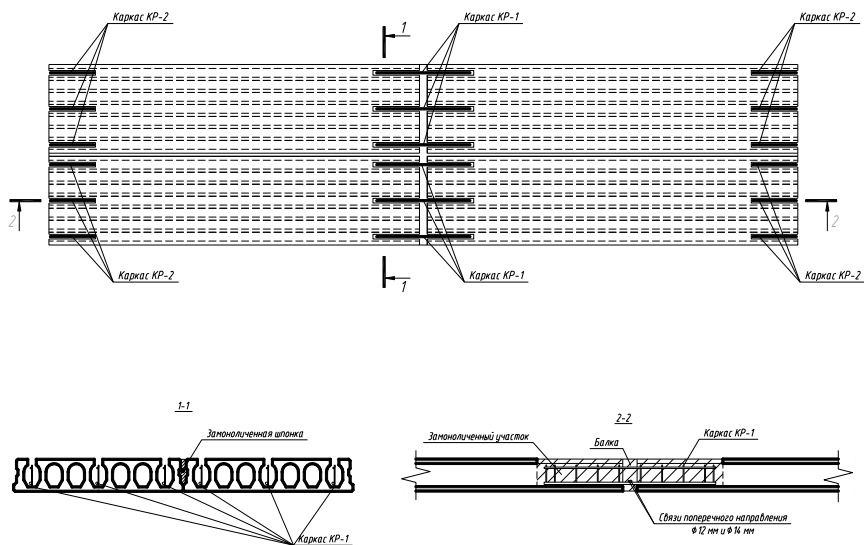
Конструкция опытного фрагмента плоского диска перекрытия
